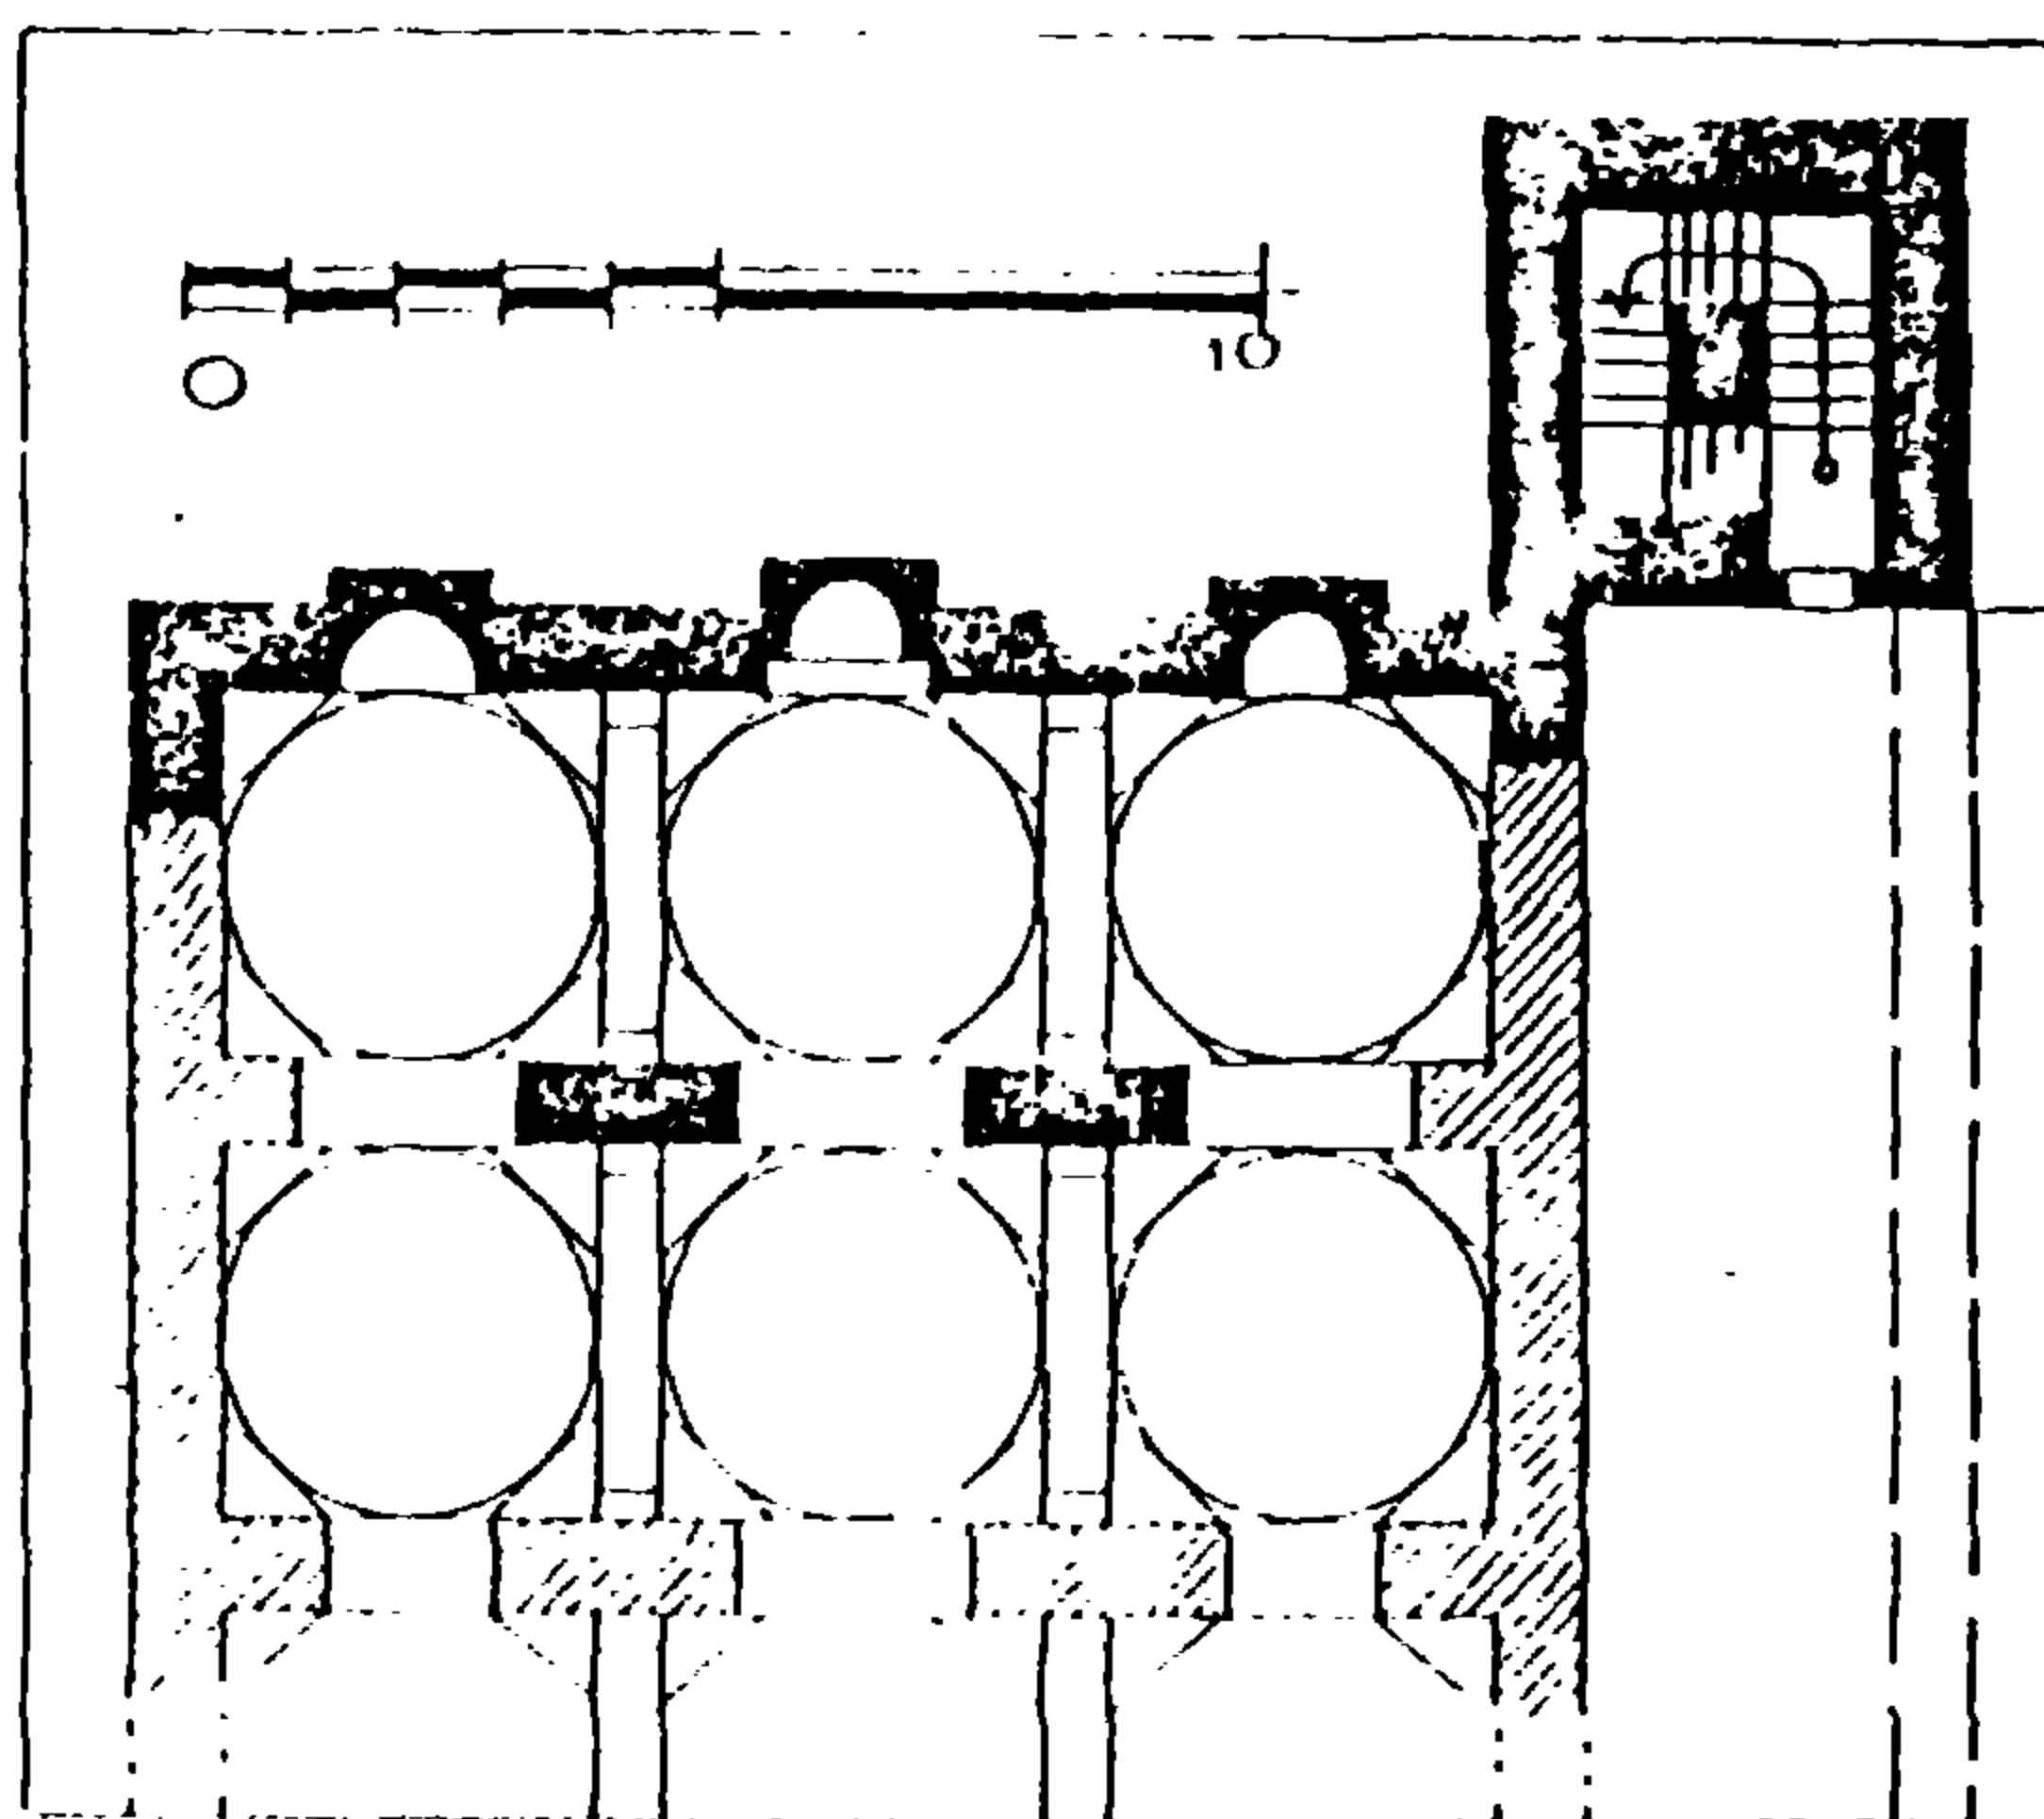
المسقط الأفقي لجامع محمد أبو الذهب
